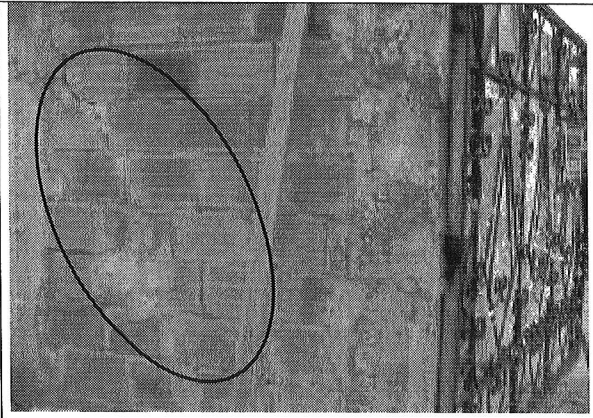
Agrietamientos en la zona cercana a la puerta de acceso.
